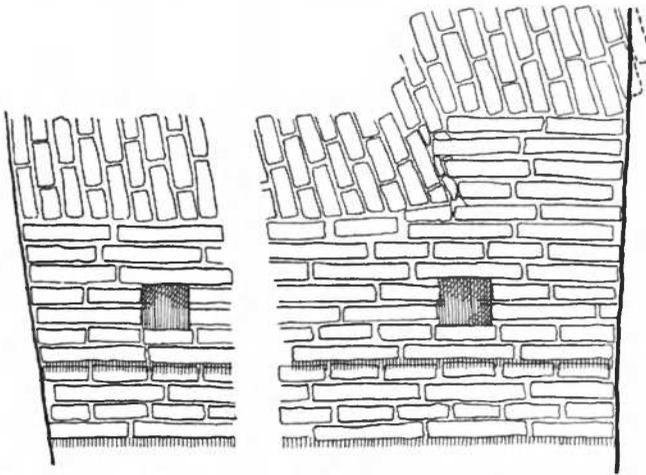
Приемы кладки сводов в древнем Пянджикенте. Примыкание к щипцовой стене
